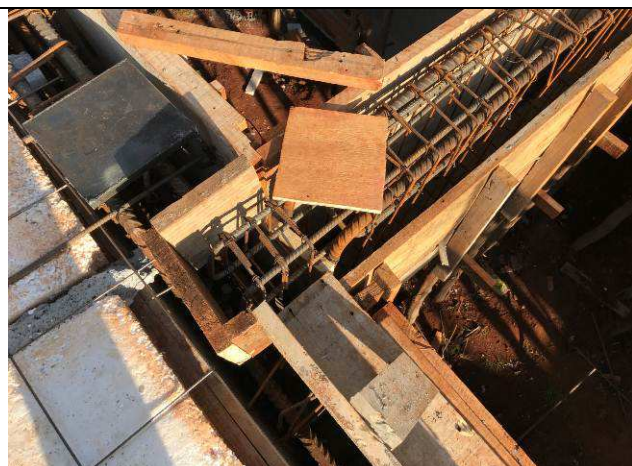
C: Formas e armaduras das vigas e lajes da cobertura - junta de dilatação.
